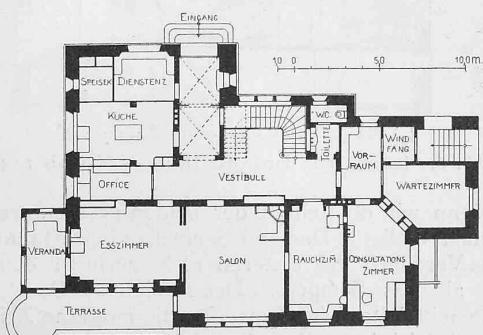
Grundriss vom Erdgeschoss. — Masstab 1:400.
